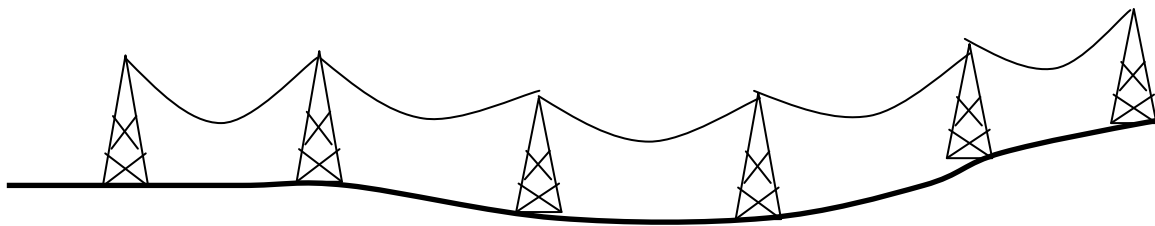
Representação do perfil e planta plano (PPP) da linha hipotética.
